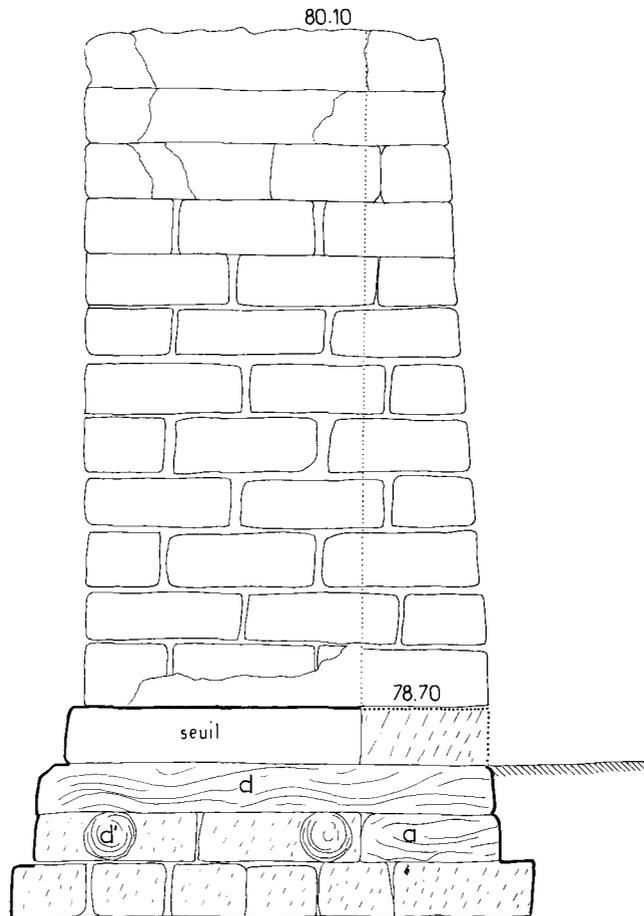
Coupe sur la porte d'entrée de la maison D.
